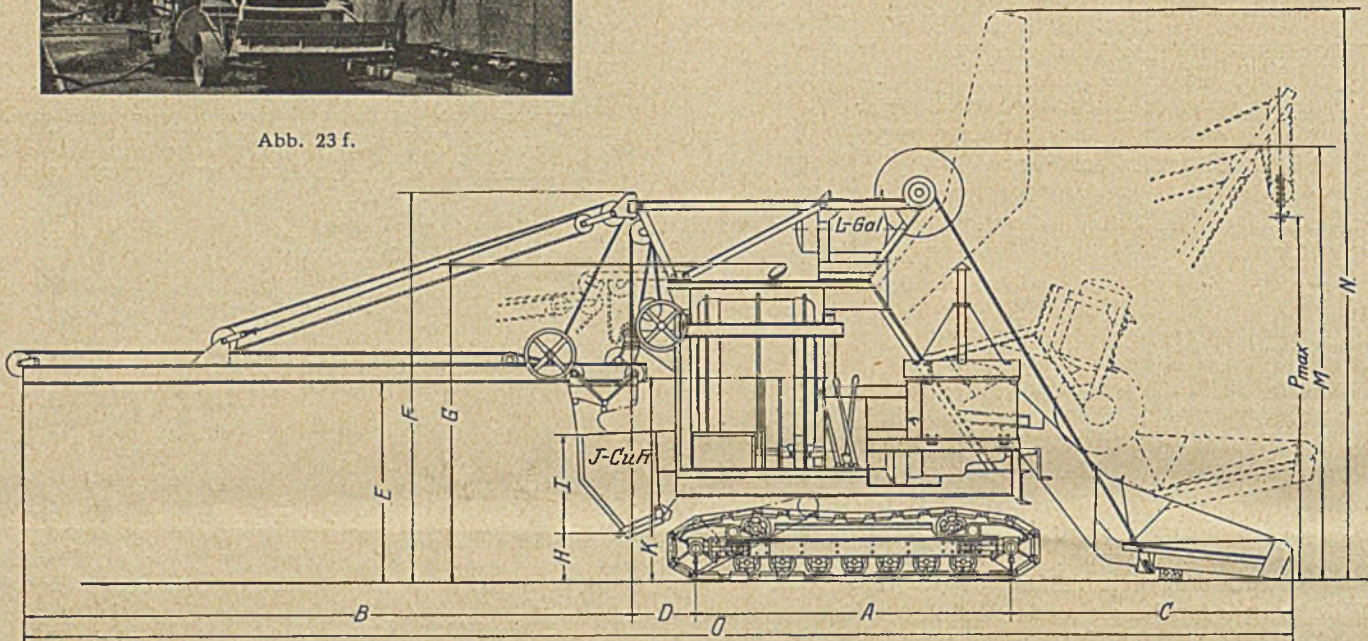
g. Typische Betonmischmaschine für den Straßenbau.
